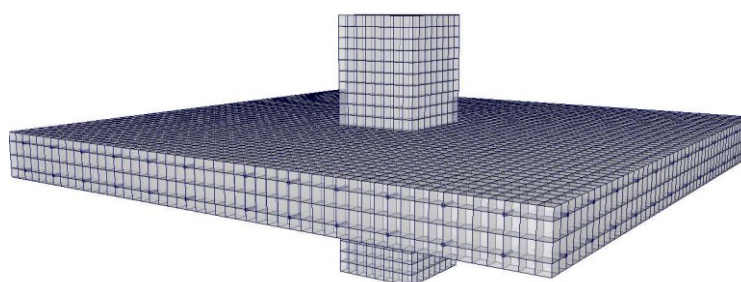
Фрагмент уточненной модели узла сопряжения колонны и плиты перекрытия.
